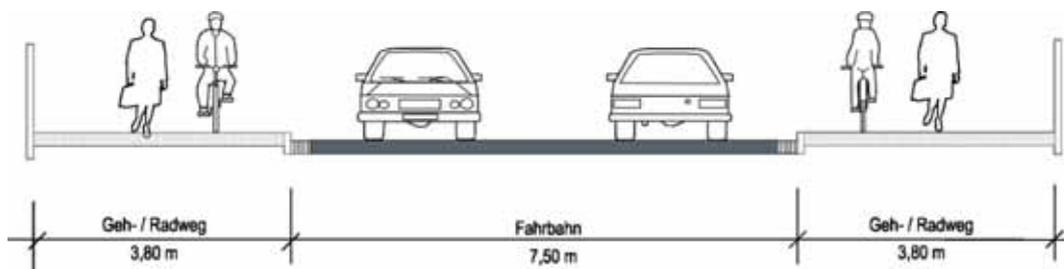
An der Friedensbrücke: Querschnitt im Bestand (Blick stadtauswärts)
